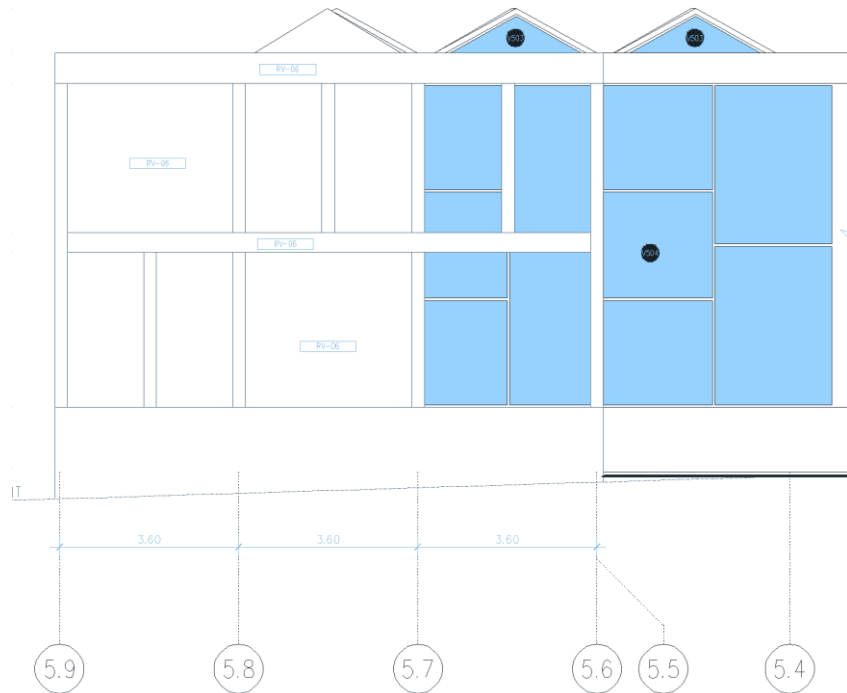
Plano Arquitectónico Elevación Oeste Biblioteca [25]
